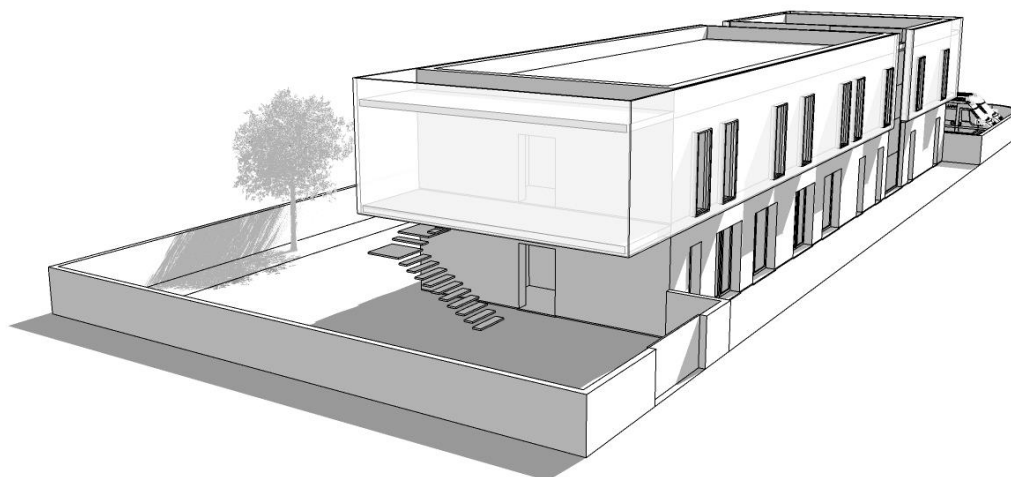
schizzo di progetto preliminare Nuova Sede Croce Rossa di Pontasserchio vista nord-ovest
